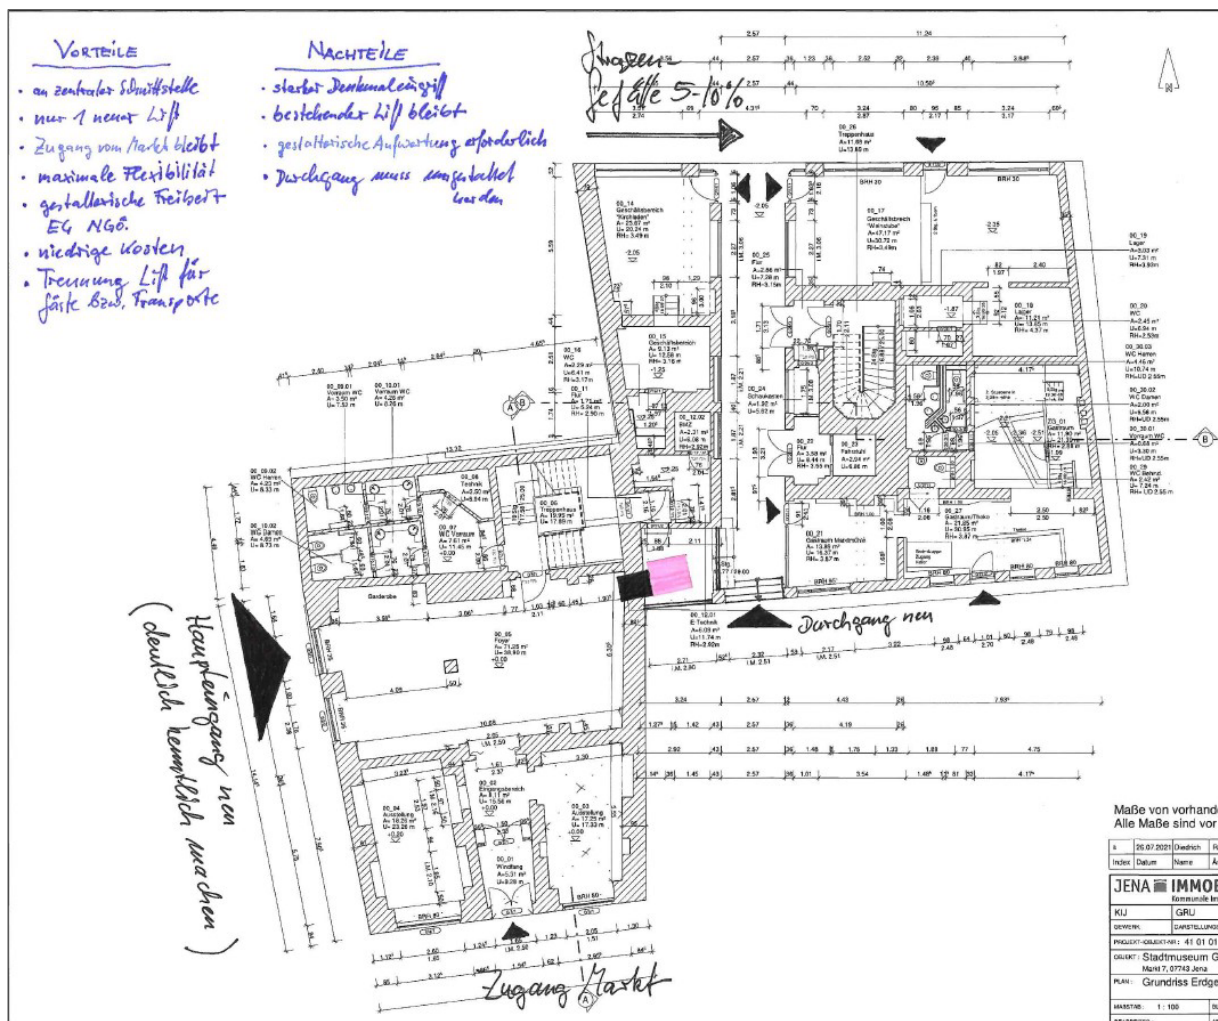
Grundriss Erdgeschoss, Positionierung Aufzug und Eingang zum Gebäude, Variante Portal;
